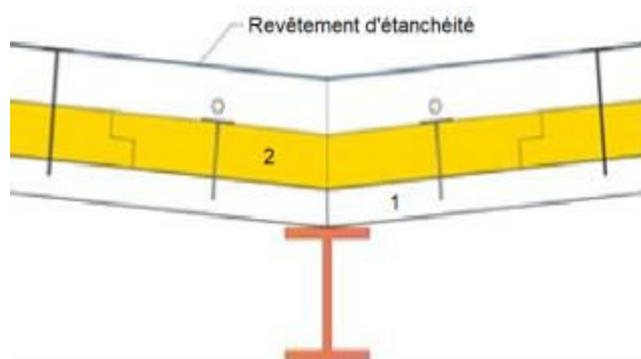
Principe de jointoiment du procédé Stisolétanch® Protect avec élément porteur tôle d'acier nervurée, sur appui unique de noue traditionnelle
